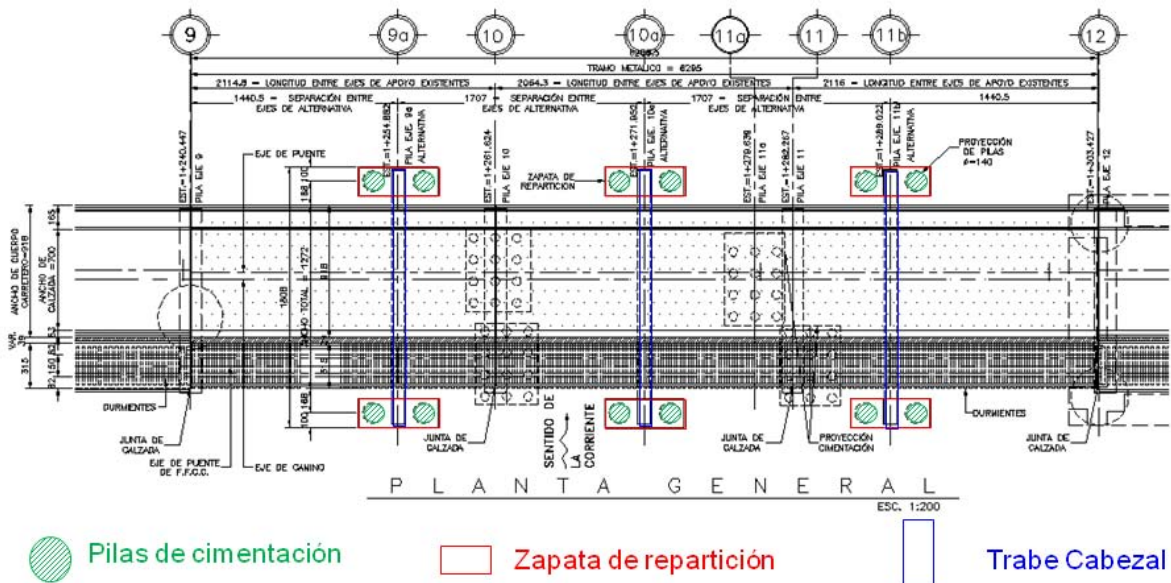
Plano general en planta del puente Coatzacoalcos I, tramo de eje 9 a eje 12 [1.3].
